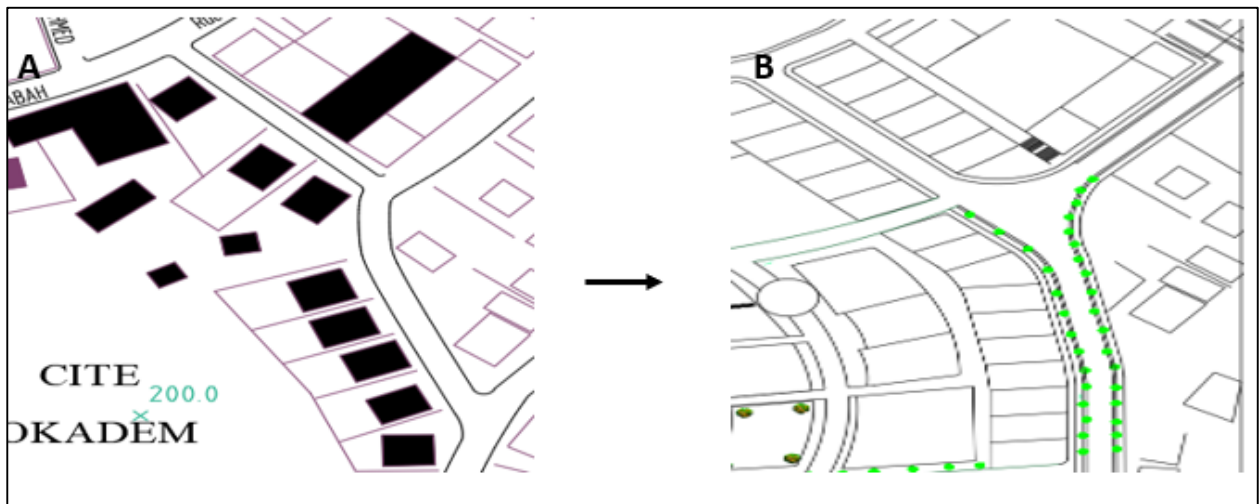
62: Vue en plan des maisons individuelles avant et après intervention.
